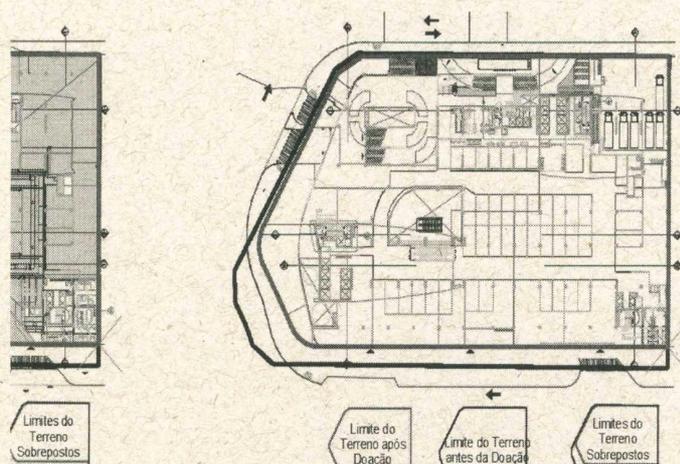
Planta Baixa do Mezanino do 1º Mall – esquemática sem escala.
